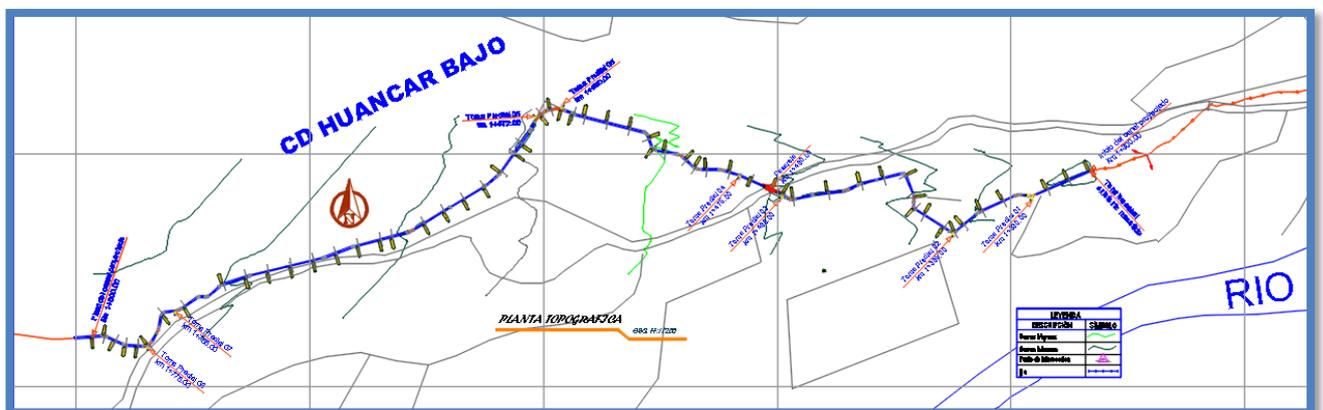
Plano de Canal Huancar Bajo, fuente: el autor
